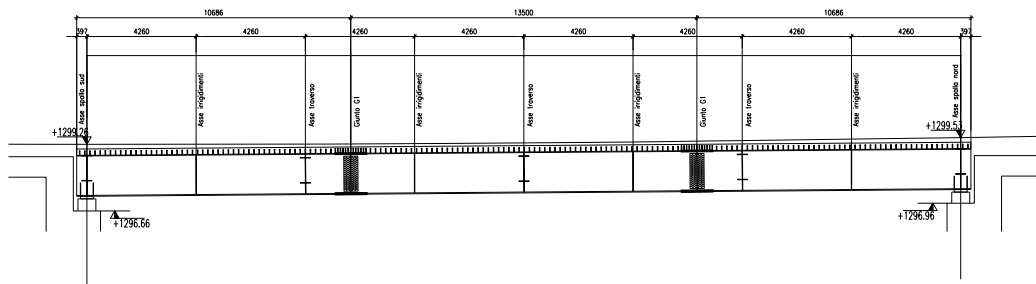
Sezione longitudinale del ponte di accesso alla galleria
